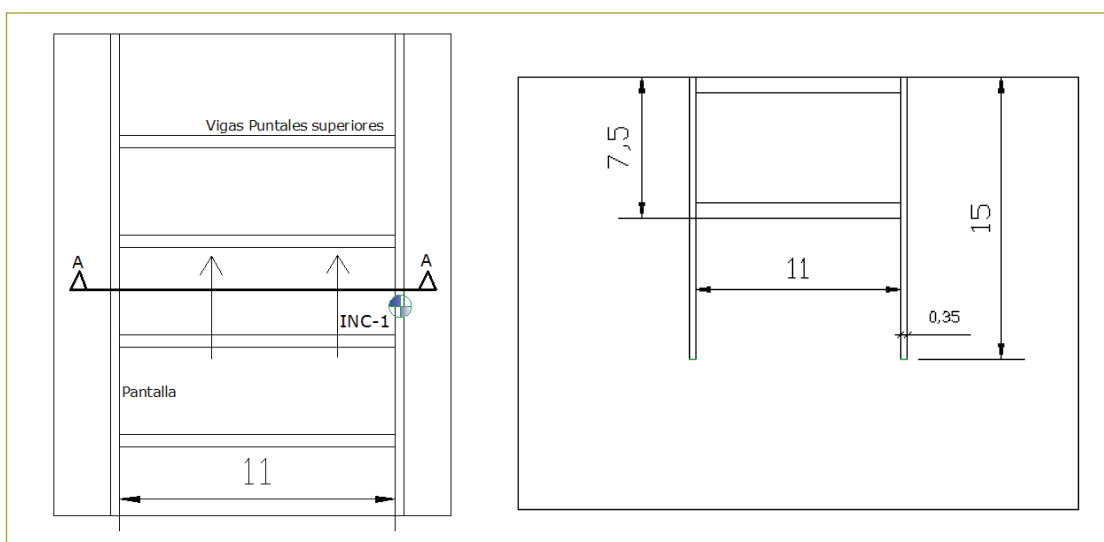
Planta y corte esquemático transversal del proyecto (sección A-A).
